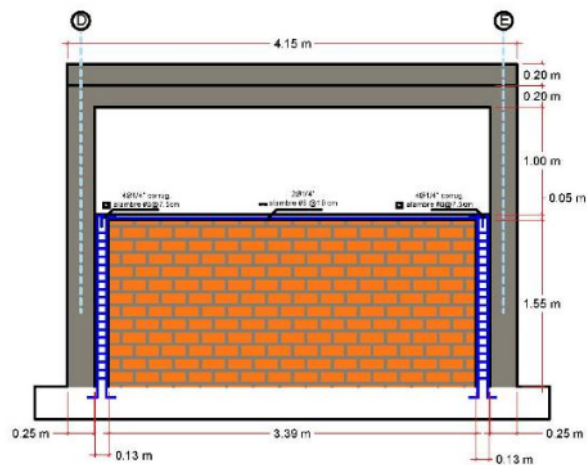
Elevación EJE 1 rigidizado con muros de 25 cm
